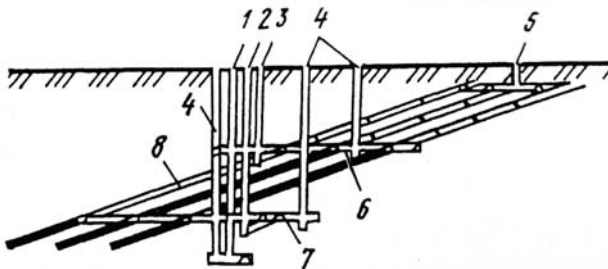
Схема вскрытия нового горизонта путем проходки вспомогательного и вентиляционных стволов, углубки действующего вспомогательного ствола с переоборудованием его в главный: 1 – новый вспомогательный ствол; 2 – главный ствол нового горизонта (углубленный и переоборудованный существующий вспомогательный ствол); 3 – главный ствол действующего горизонта; 4 – вентиляционные стволы; 5 – вентиляционный шурф; 6 – вентиляционный квершлаг, 7 – погоризонтный транспортный квершлаг, 8 – бремсберг с ходками
